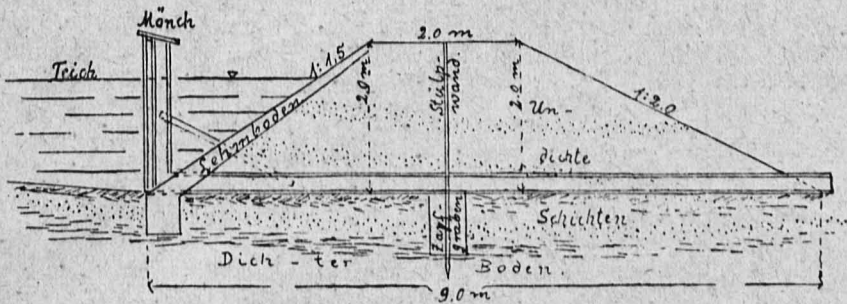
Teichdamm mit Mönch, Zapfgraben, Stülpwand, Tondichtung
